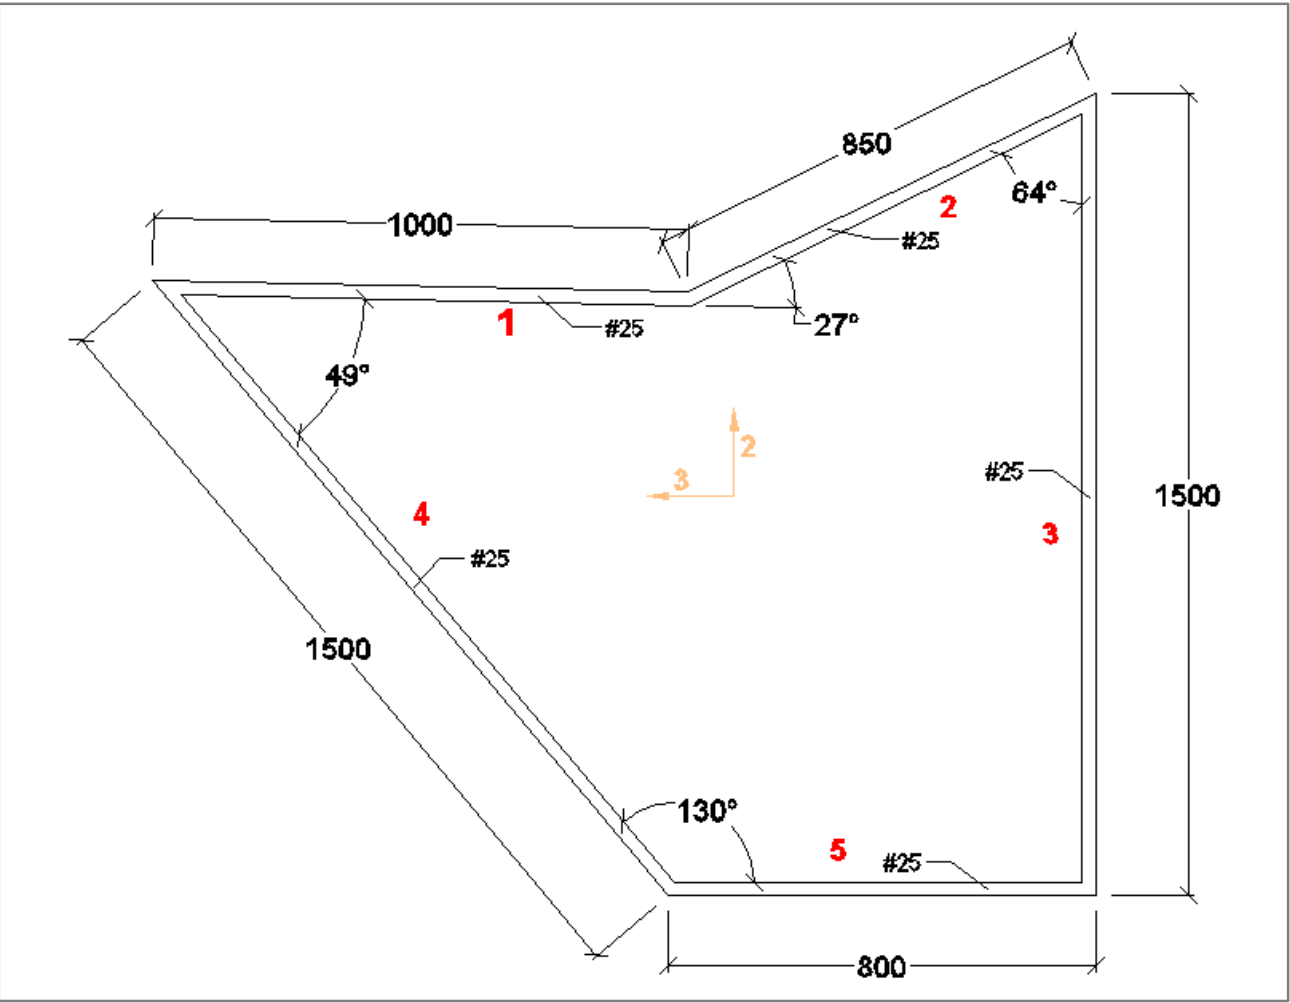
Dimensiones cajón centro luz de arcos (Cotas en mm)
